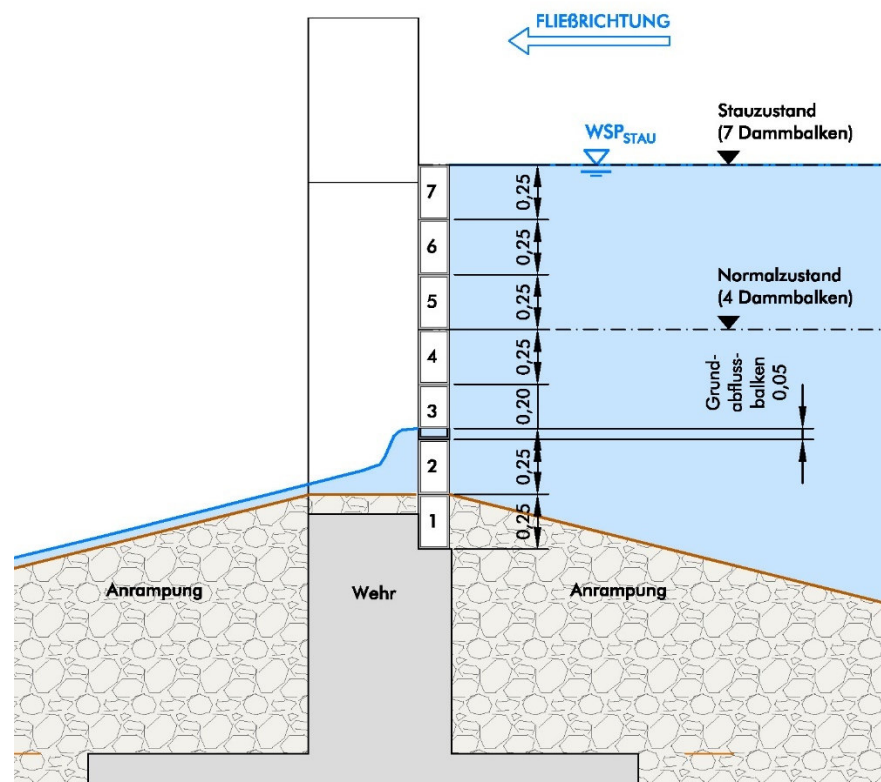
Schnitt Grundabflussbalken im Einbauzustand
